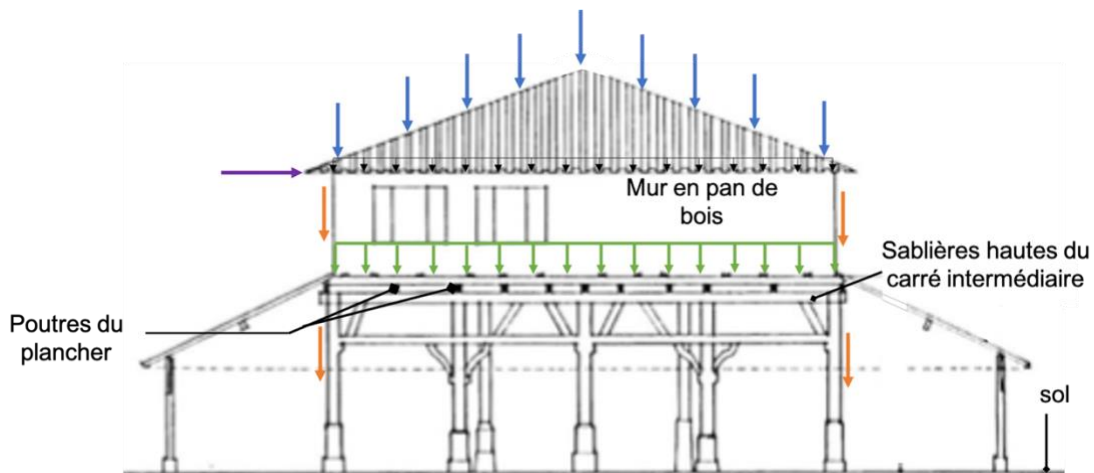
Élévation Ouest de la halle montrant le cheminement des charges verticales du haut vers les fondations de la structure
